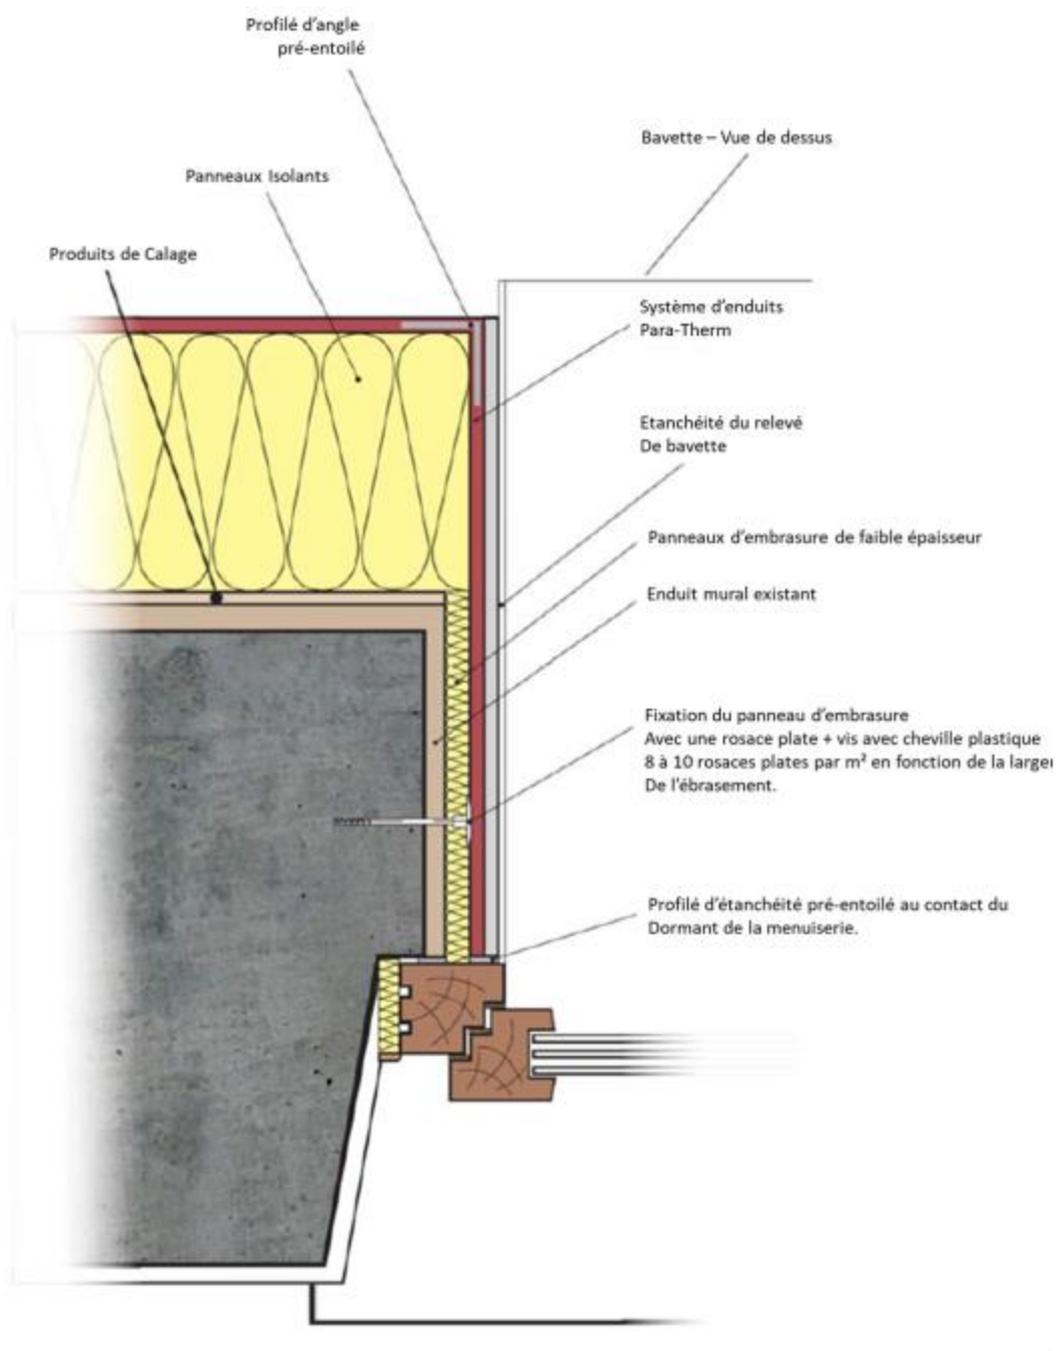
Mise en œuvre des panneaux d'embrasure dans le cas d'une rénovation (enduit existant)
